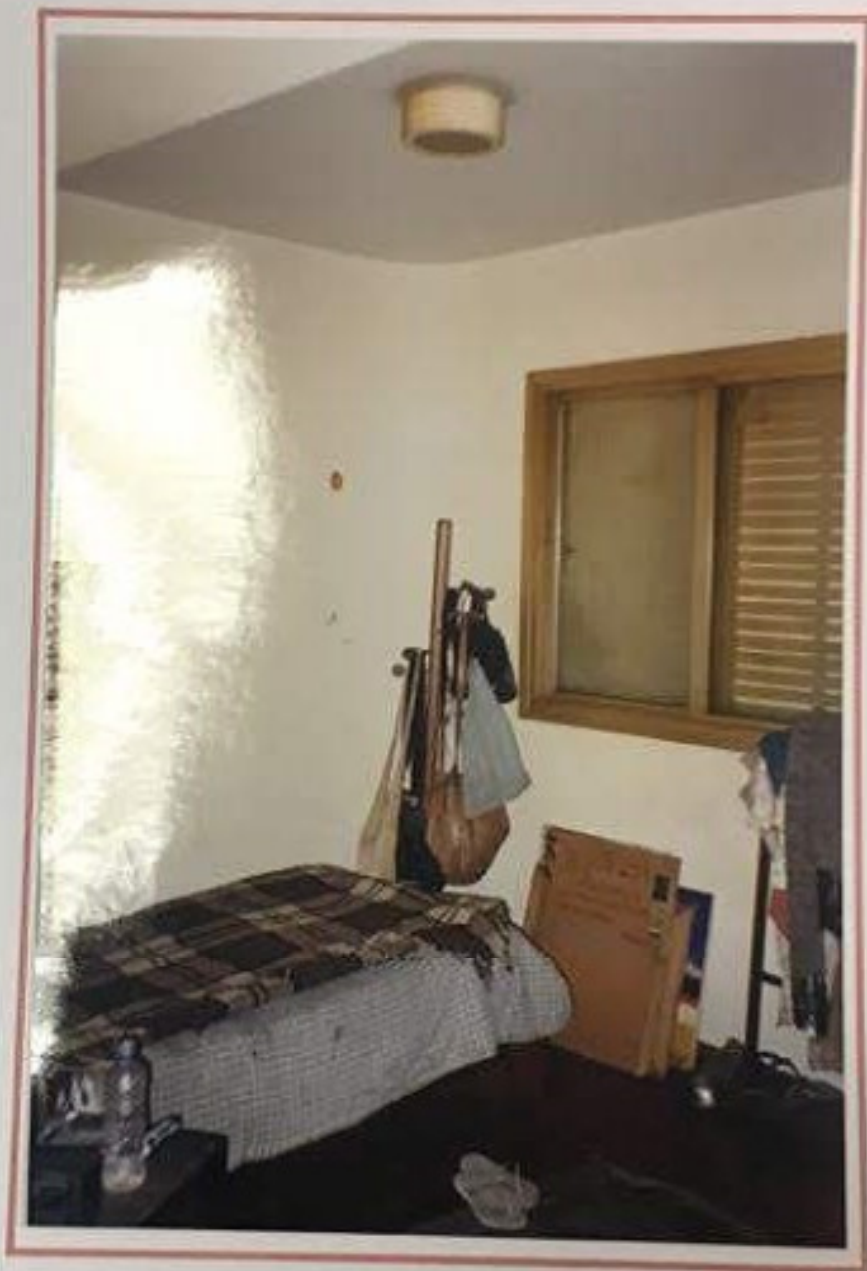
Vista parcial do dormitório, atualmente unificado sem divisão.
